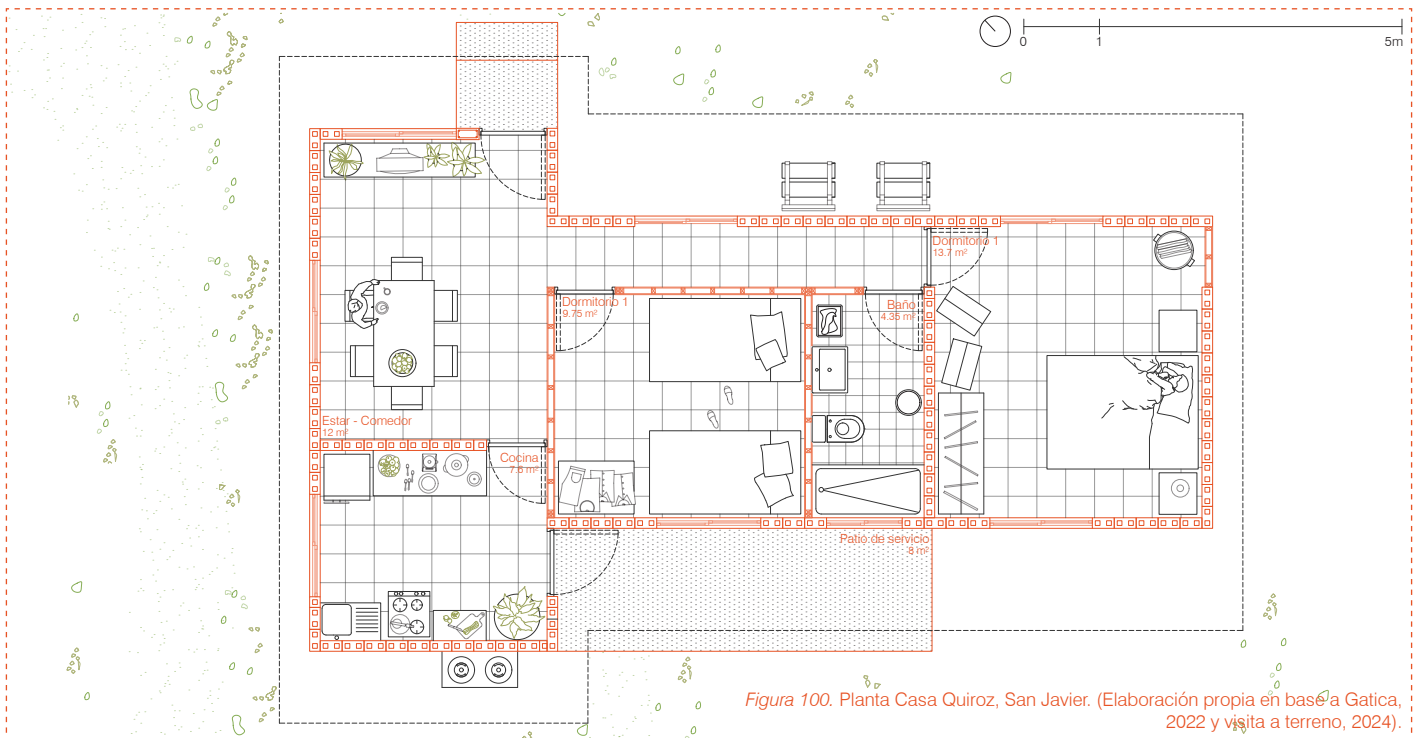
Planta Casa Quiroz, San Javier. (Elaboración propia en base a Gatica, 2022 y visita a terreno, 2024).
